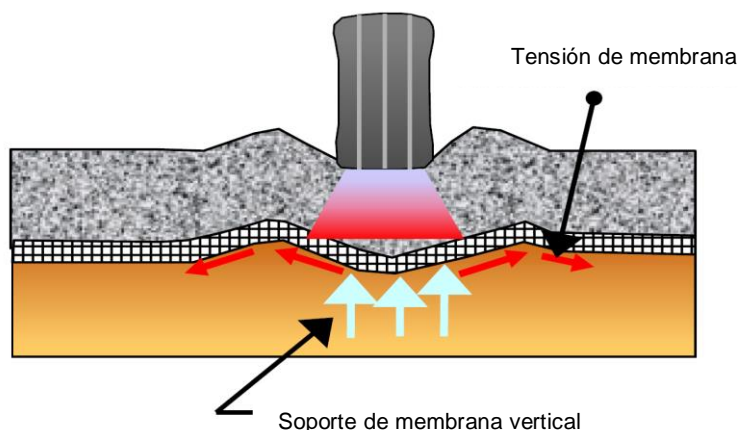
Efecto de Membrana Tensionada (Fuente: Use of Geogrids in Pavement Construction. USACOE ETL 1110-1-189)
